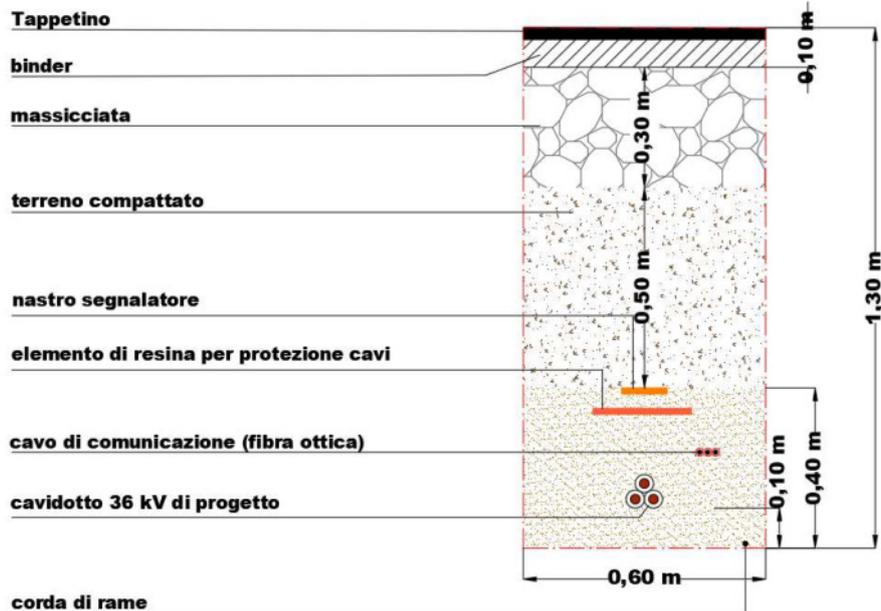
Sezione del cavidotto singola Terna su strada asfaltata
